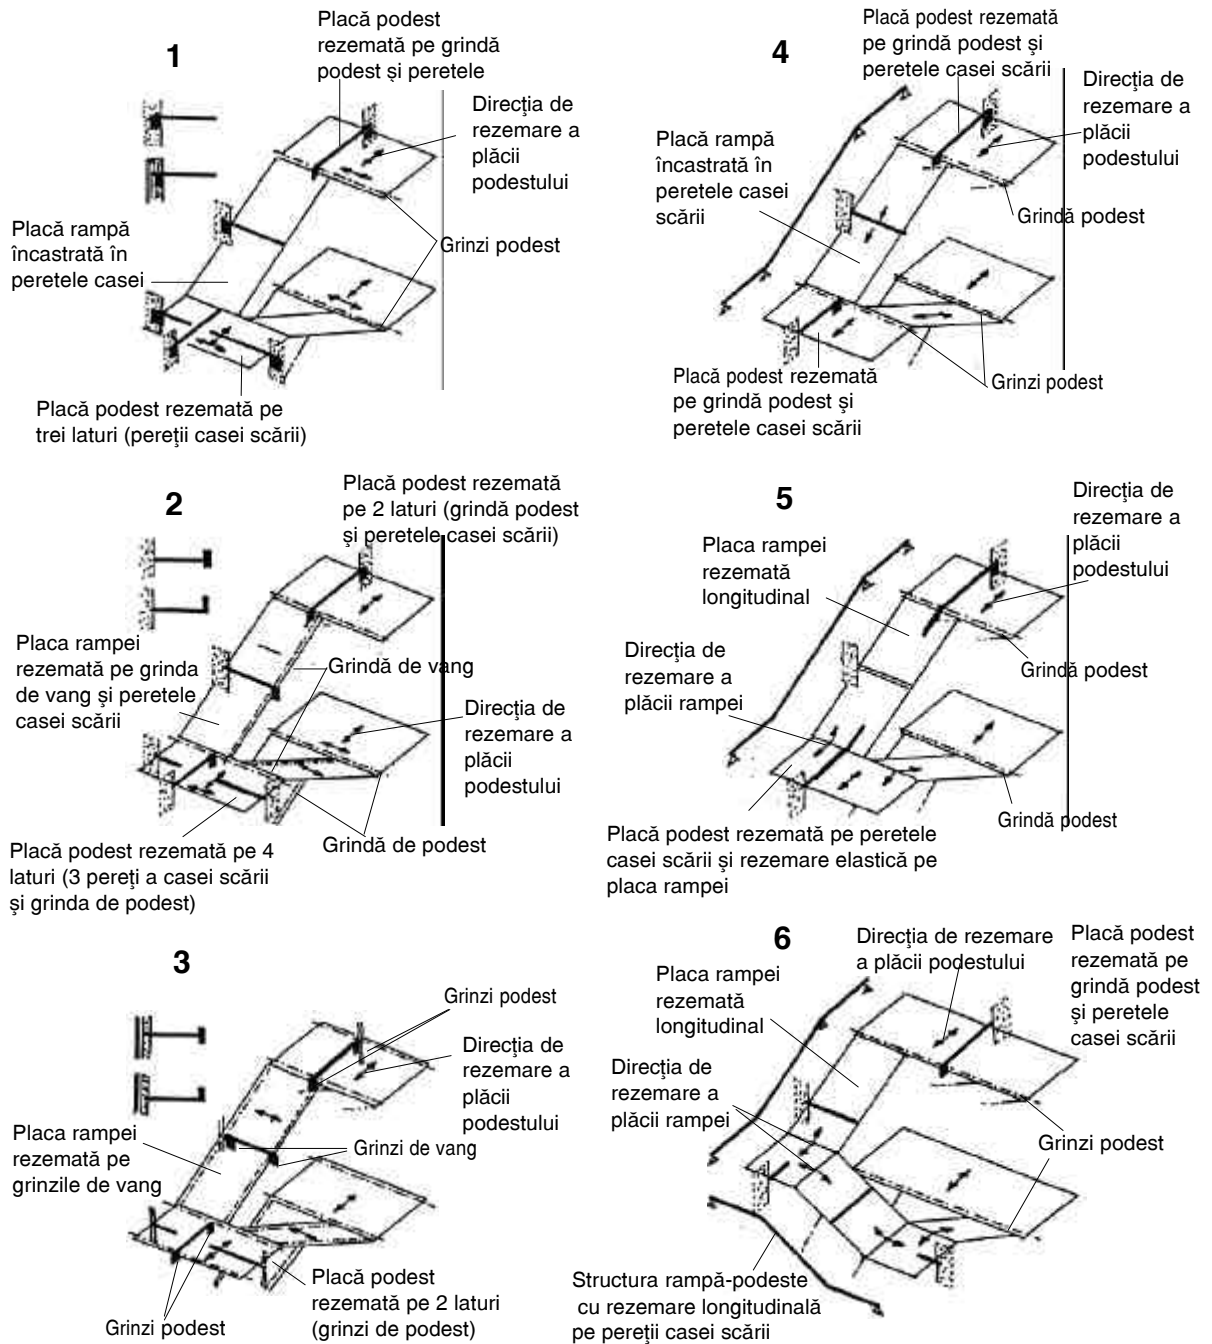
Scări din beton armat. Structuri de rezistență care lucrează după direcție transversală (1,2,3) sau longitudinală (4,5,6).
